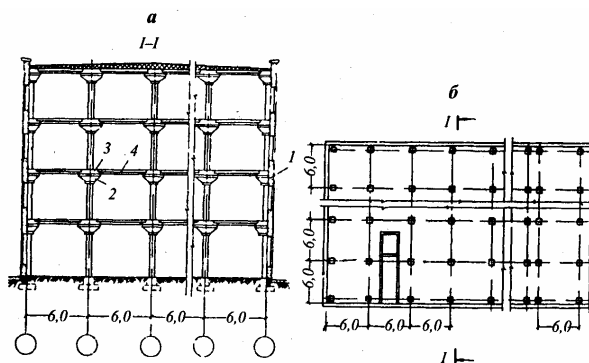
Многоэтажное здание с безбалочными перекрытиями:
